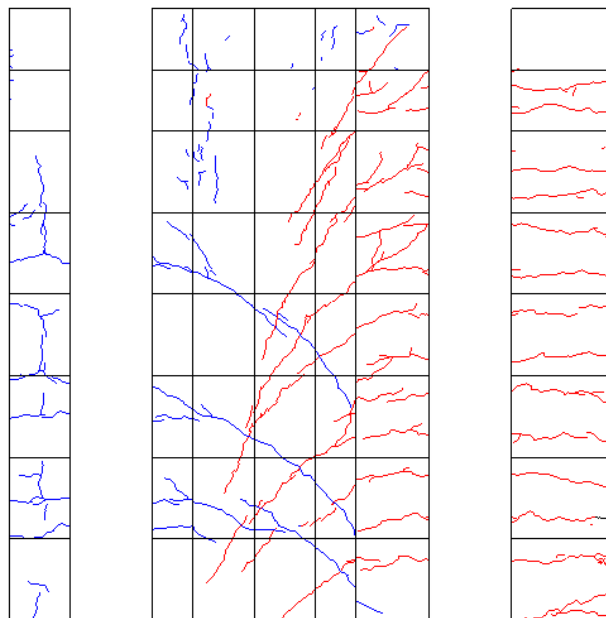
R=-1/133 ひび割れ図
